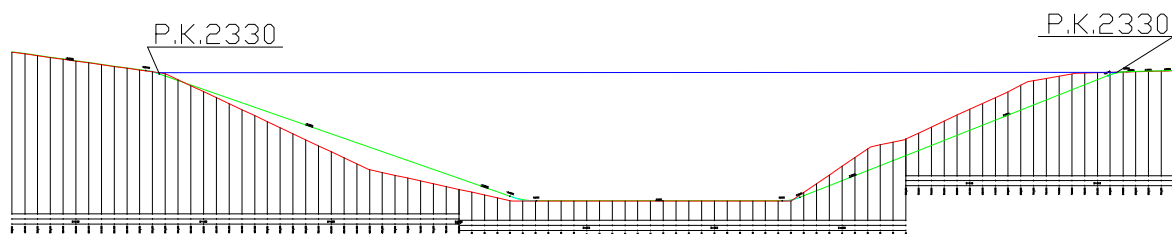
Croquis de perfil longitudinal y puente de la Alternativa 4.
